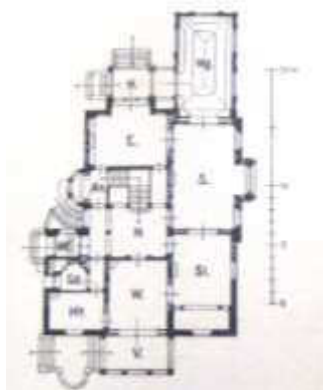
Grundriss Villa J. J. A. Classen.
